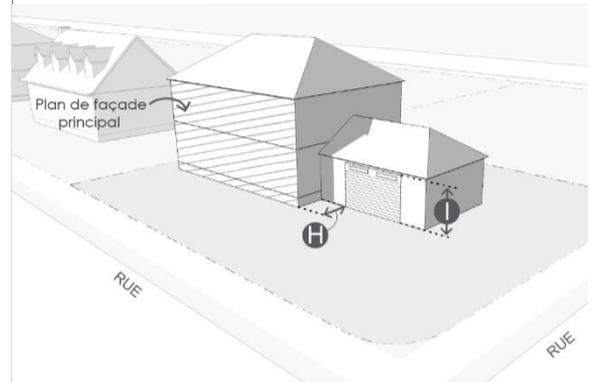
Retrait d'un garage par rapport à un plan de façade principal et hauteur d'une porte de garage
